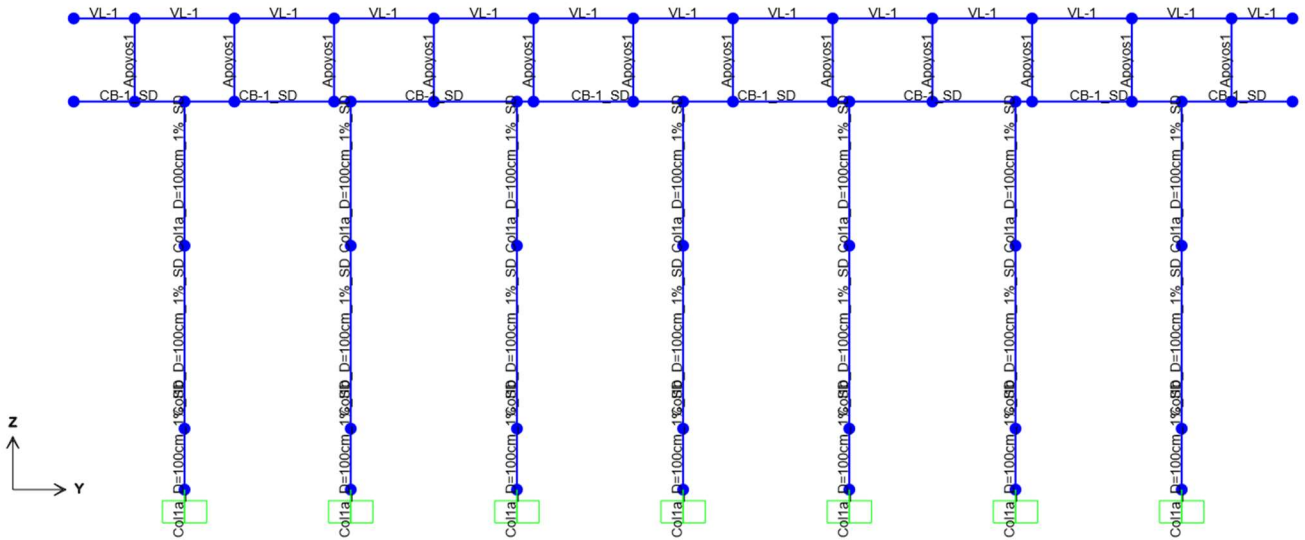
Puente Santo Domingo, elementos estructurales del marco M-1 y M-3
